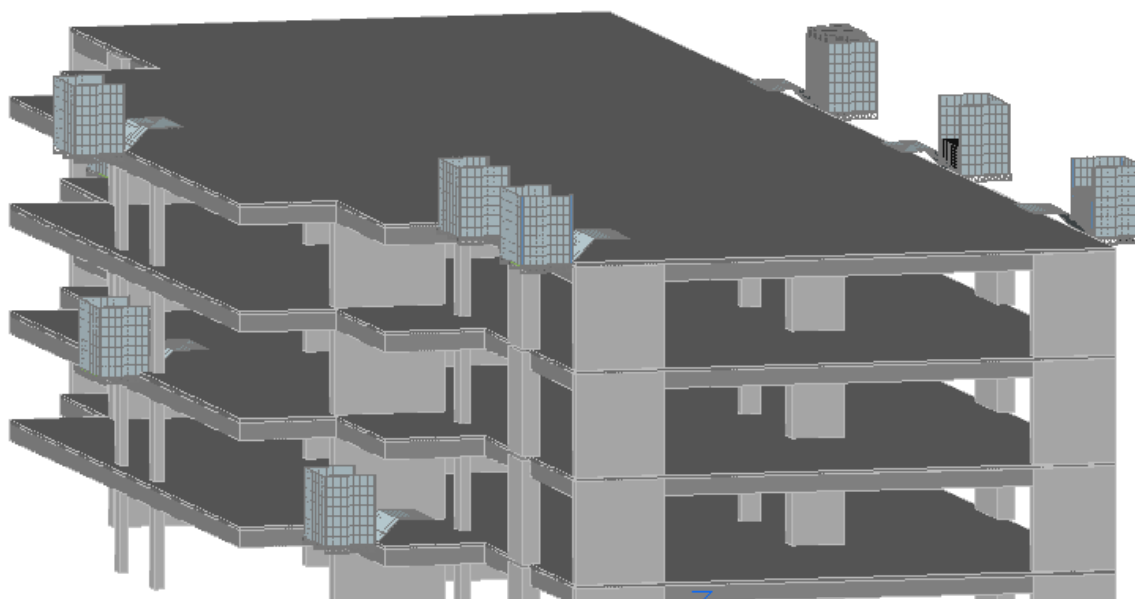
Solução para transporte de recursos com a grua nos pavimentos inferiores
